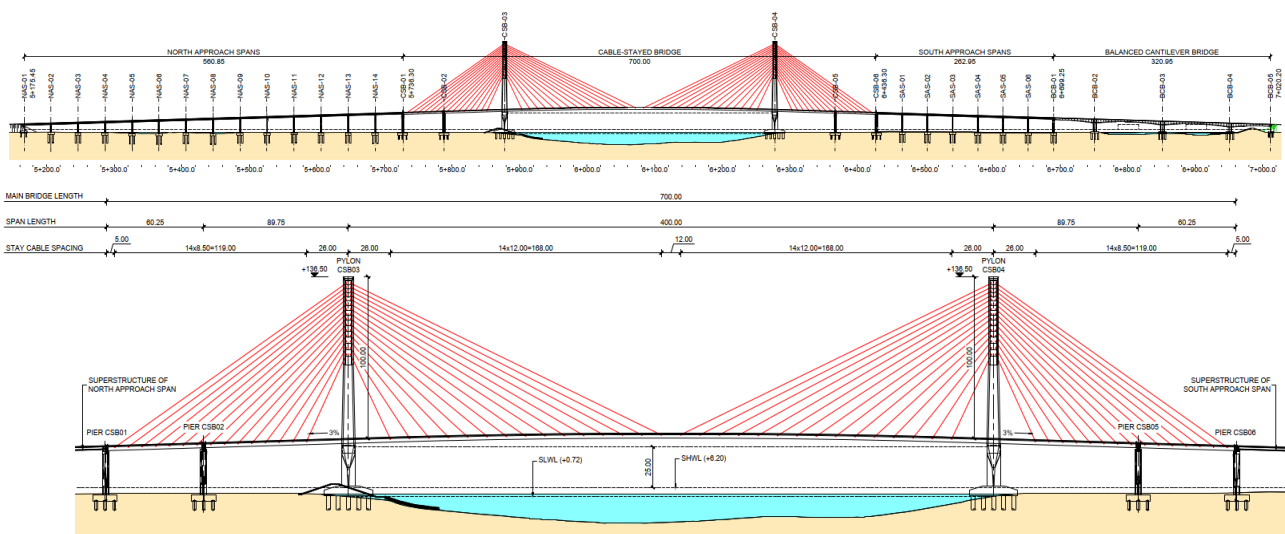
Alzado general del puente (arriba) y del tramo atirantado (abajo).
